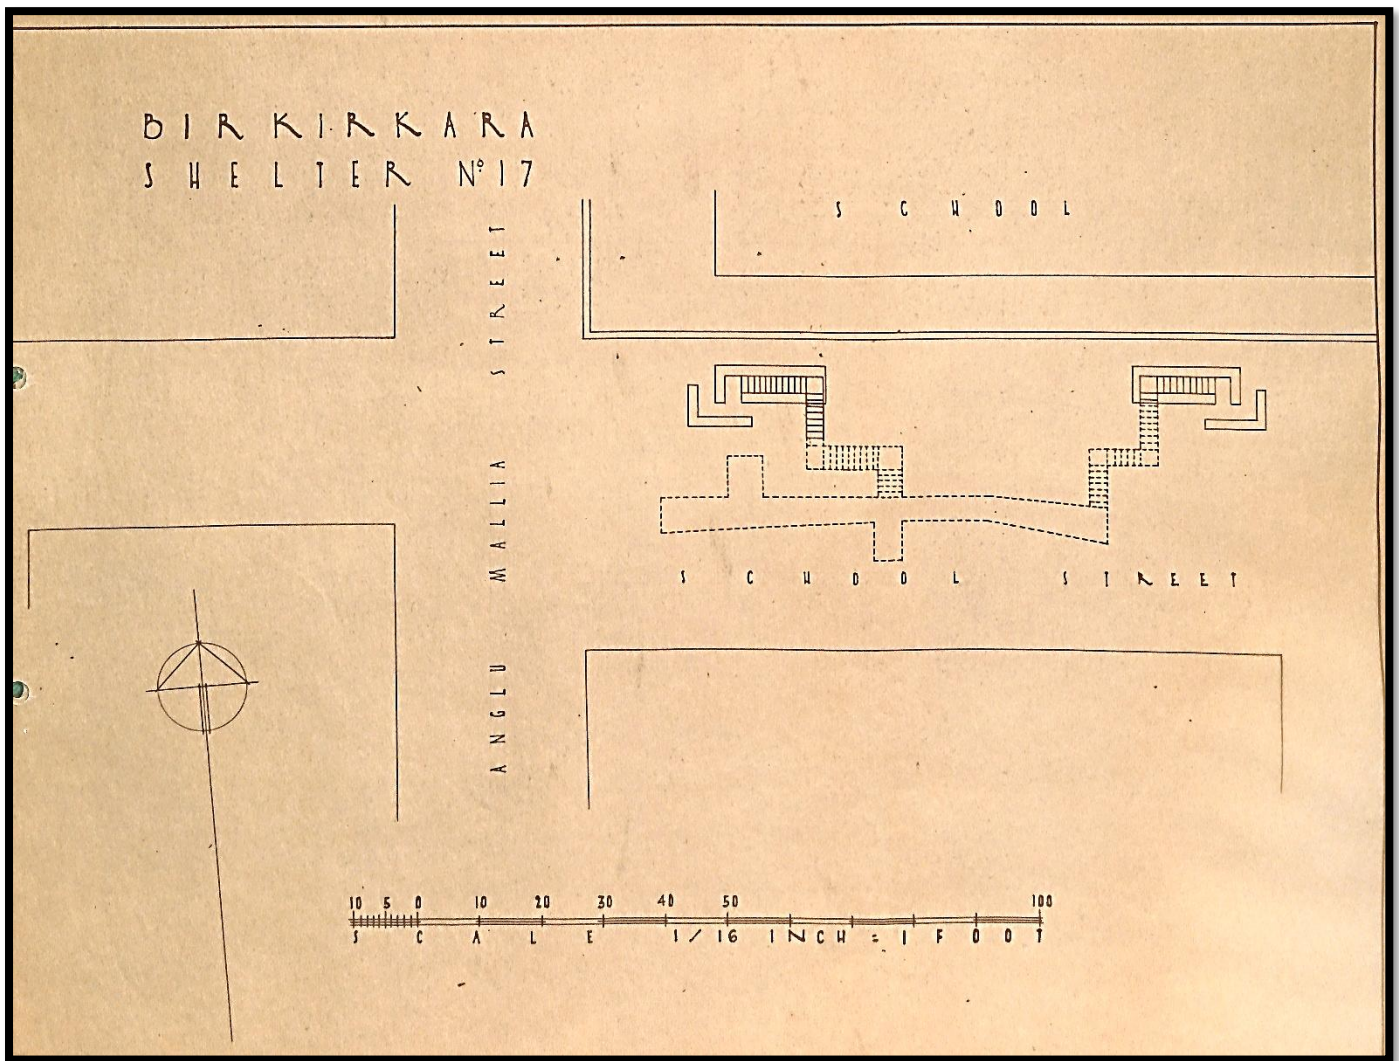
Planta do Abrigo nº 17 "Anglu Mallia Street"
